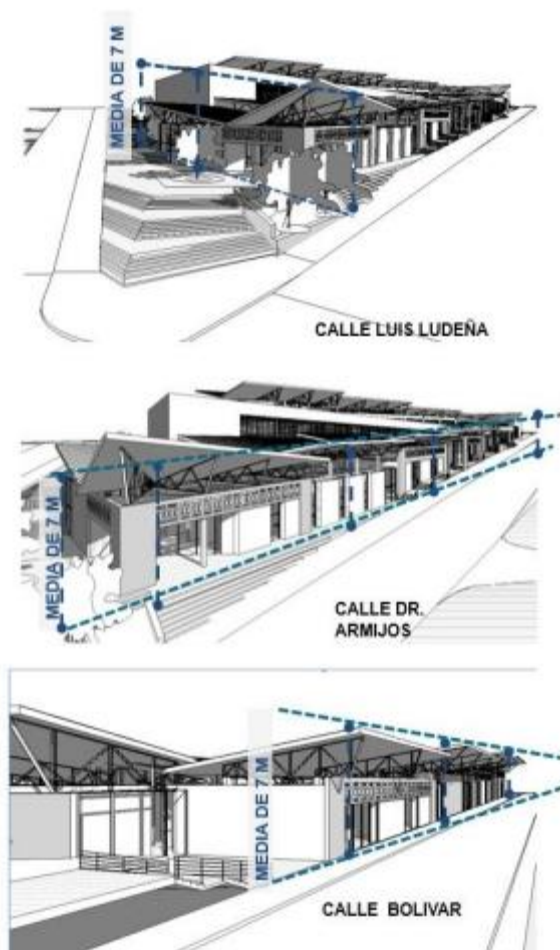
Altura de Fachada hacia la calle Bolívar
